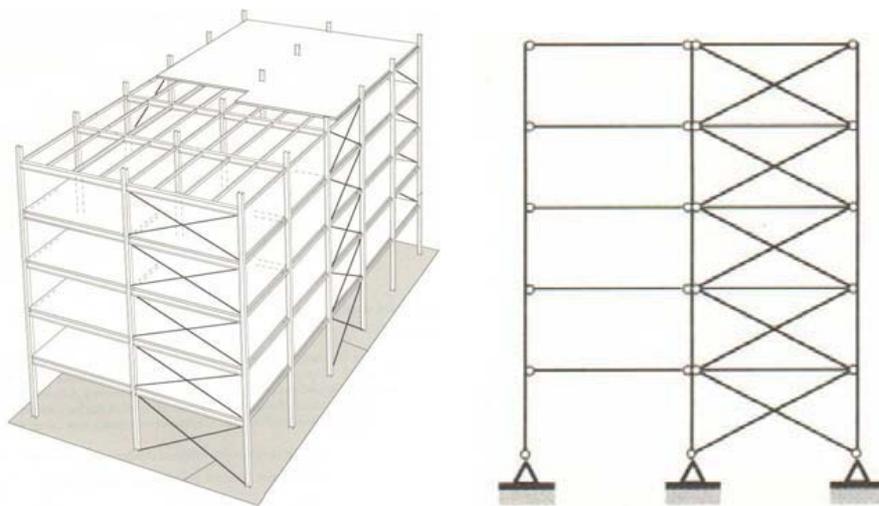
Esquema de contraventamento vertical para edifícios baixos
